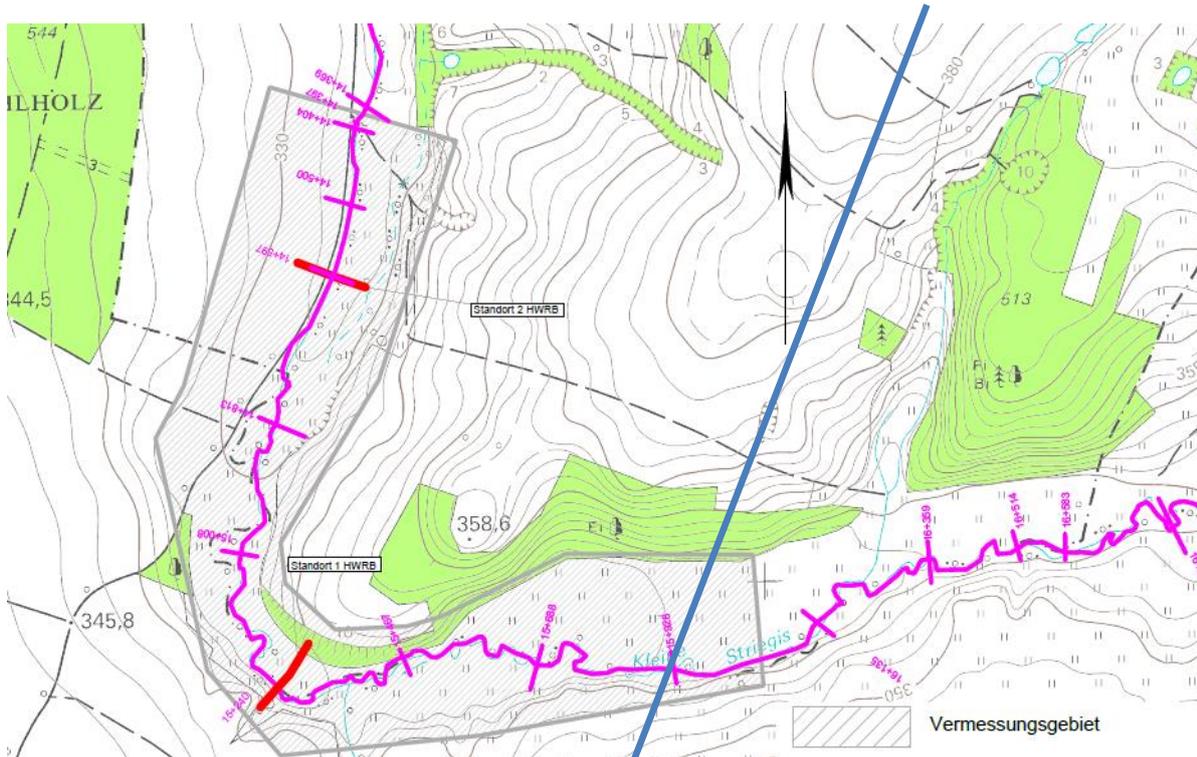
Lageplan der alternativen Beckenstandorte I und II
